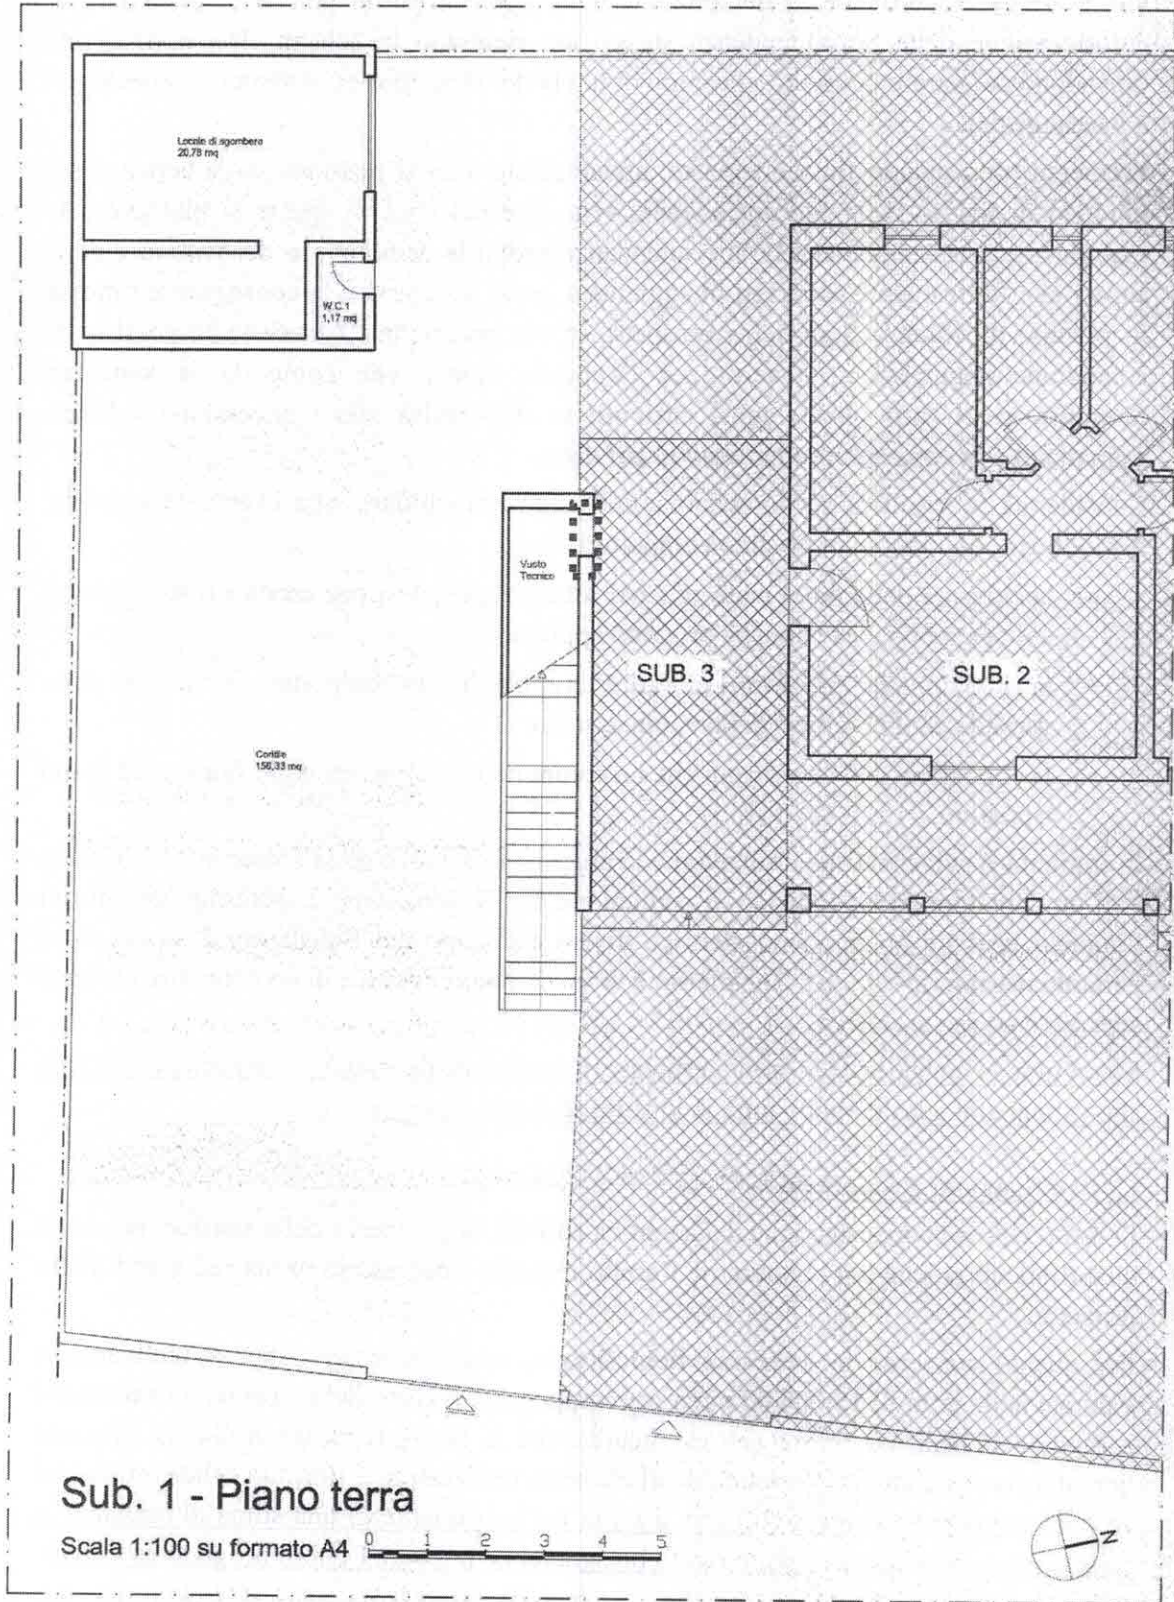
Subalterno 1 – Piano Terra – Planimetria dello stato di fatto rilevato con evidenziati gli elementi difforni rispetto a quanto approvato
